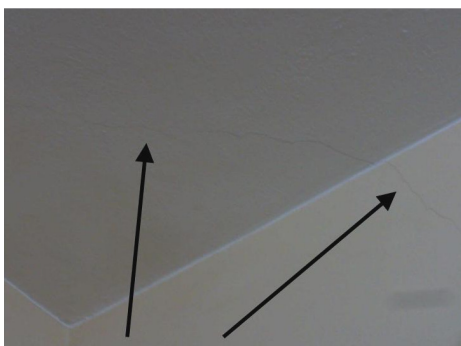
Fissuração observada entre laje e a parede.
